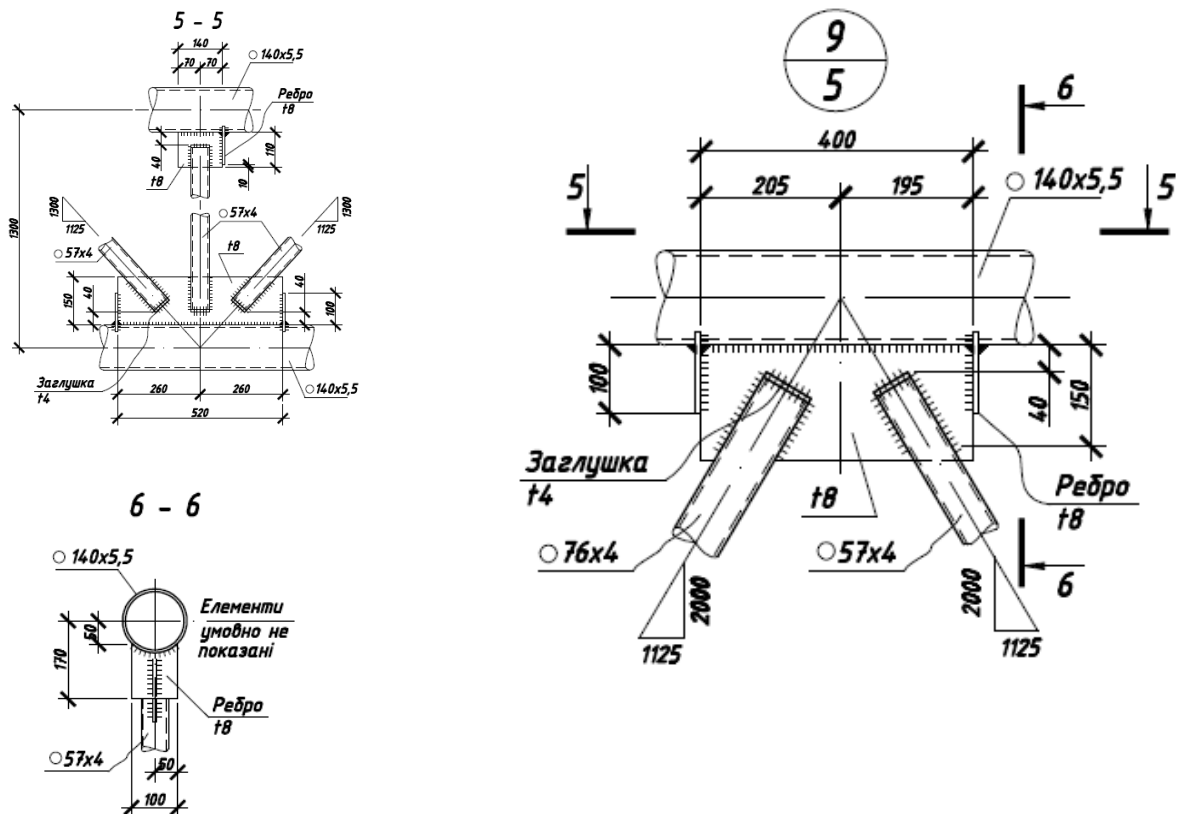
Основні вузли з'єднання елементів решітки з поясами ферм
